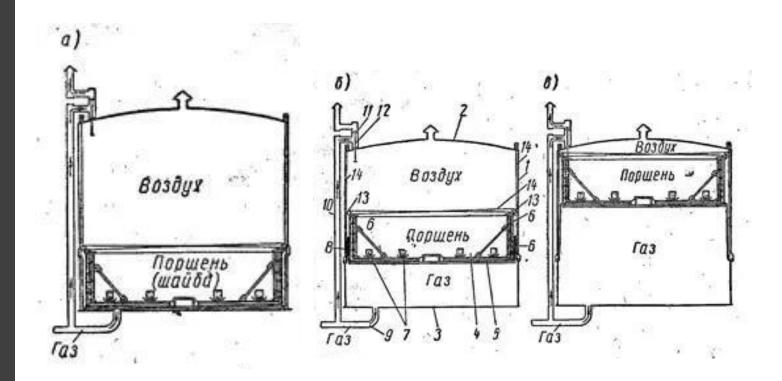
Схема сухого газгольдера с гибкой связью поршия с корпусом
